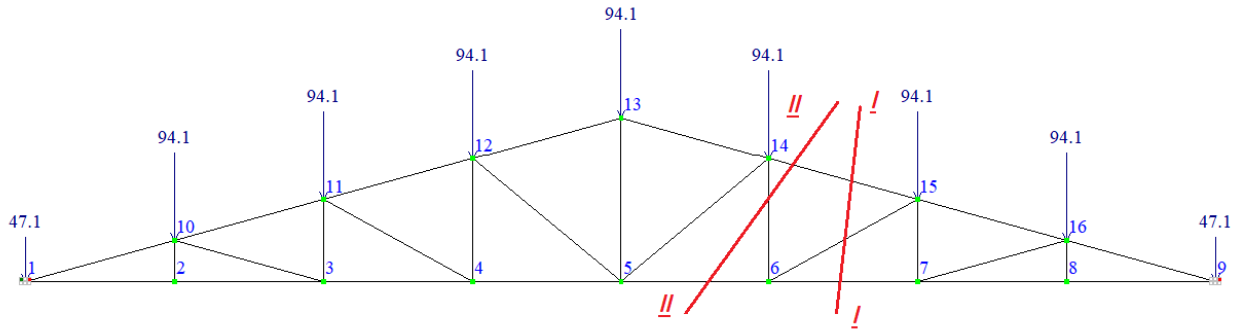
Схема розташування наскрізних перерізів ферми
